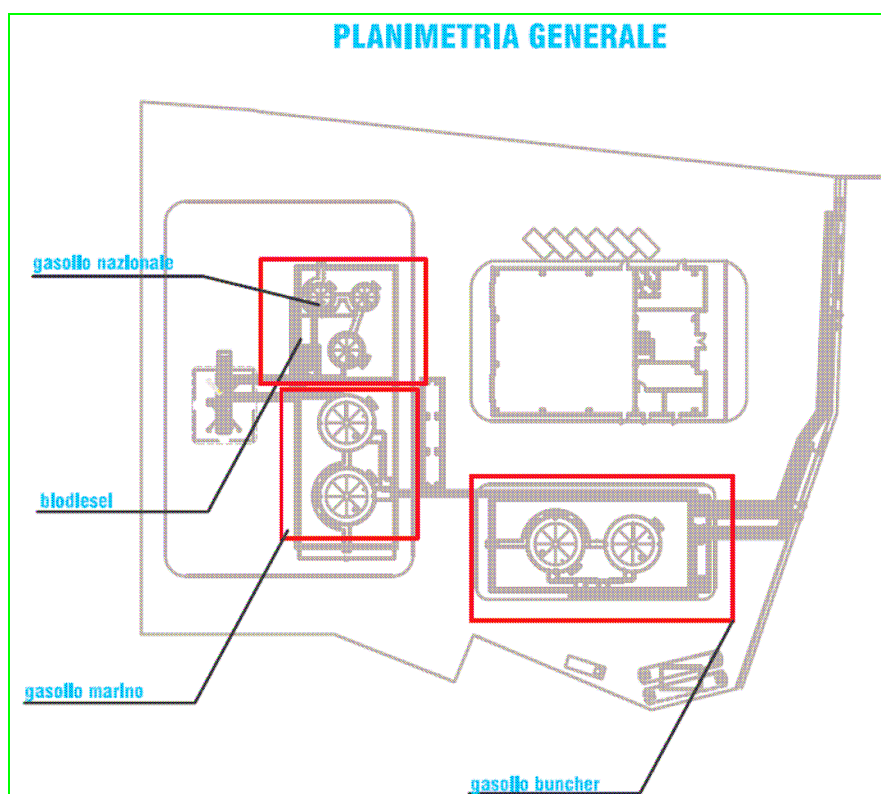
Planimetria generale di progetto (per i dettagli si rimanda al progetto), per la parte stoccaggio gasolio.
